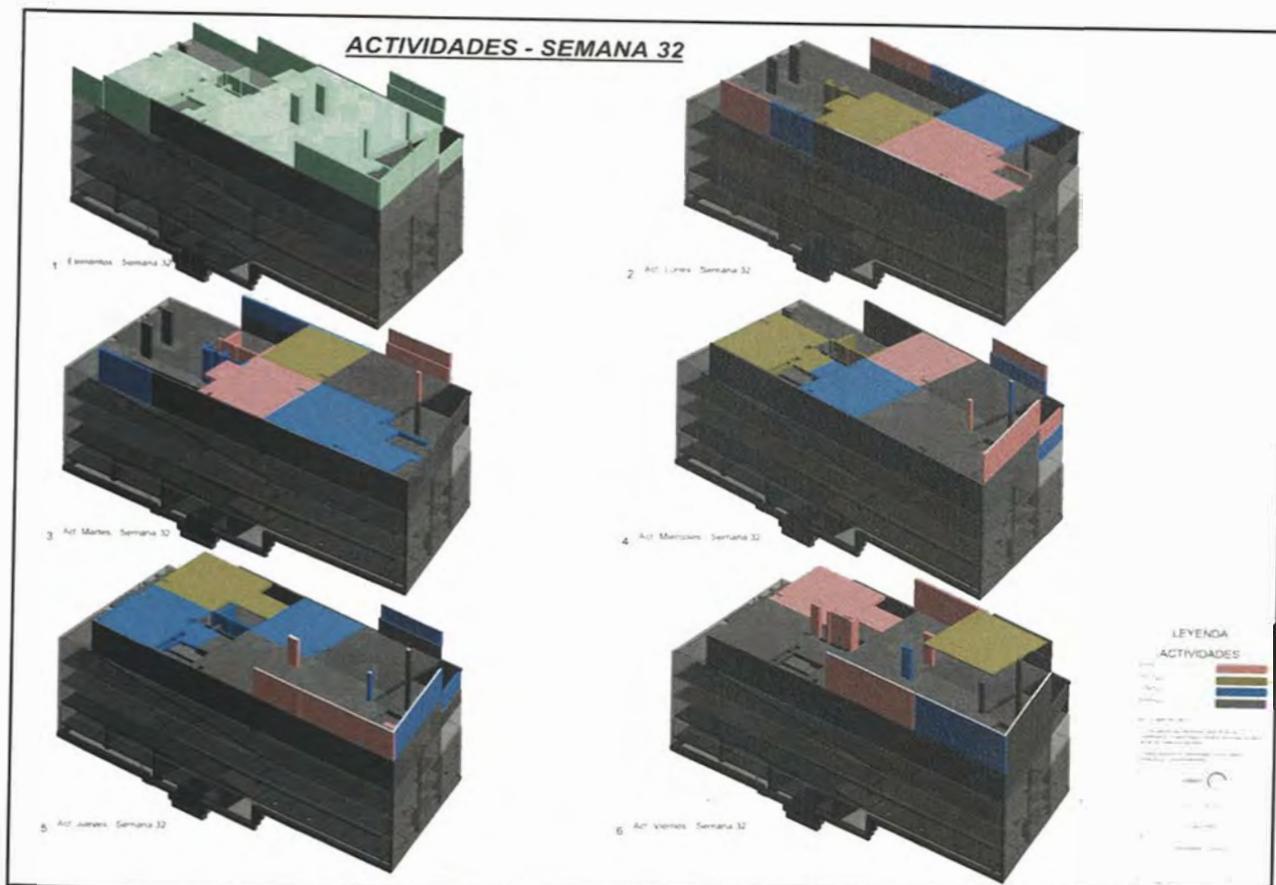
Uso del sistema Last Planner 4D para la Planificación Semanal
